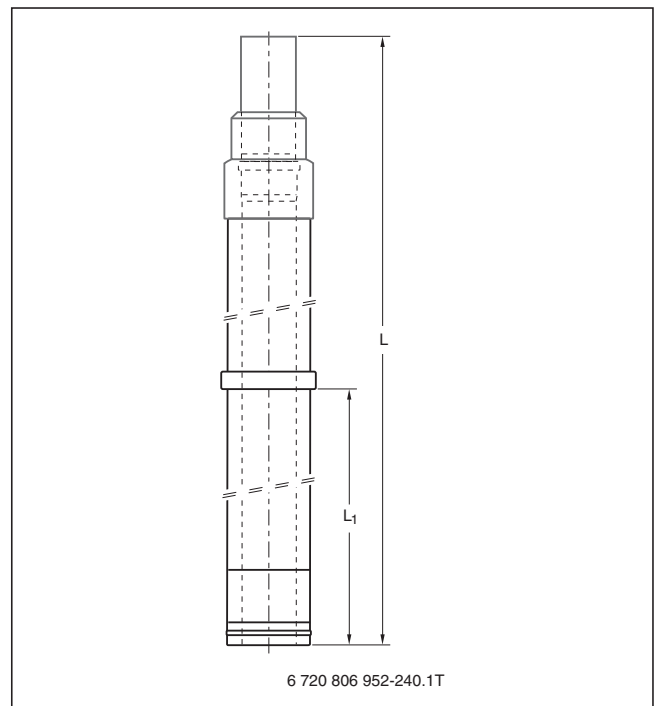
Dachdurchführung mit Mündungsabschluss für Bausatz GAF-K (Edelstahl)
